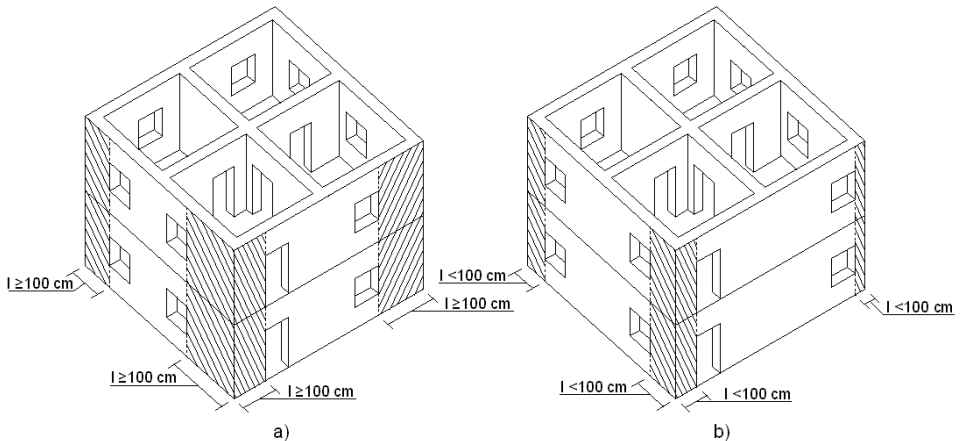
a) Lunghezza minima di muratura agli incroci tra pareti per muratura ordinaria; b) Lunghezza minima di muratura agli incroci per muratura armata
